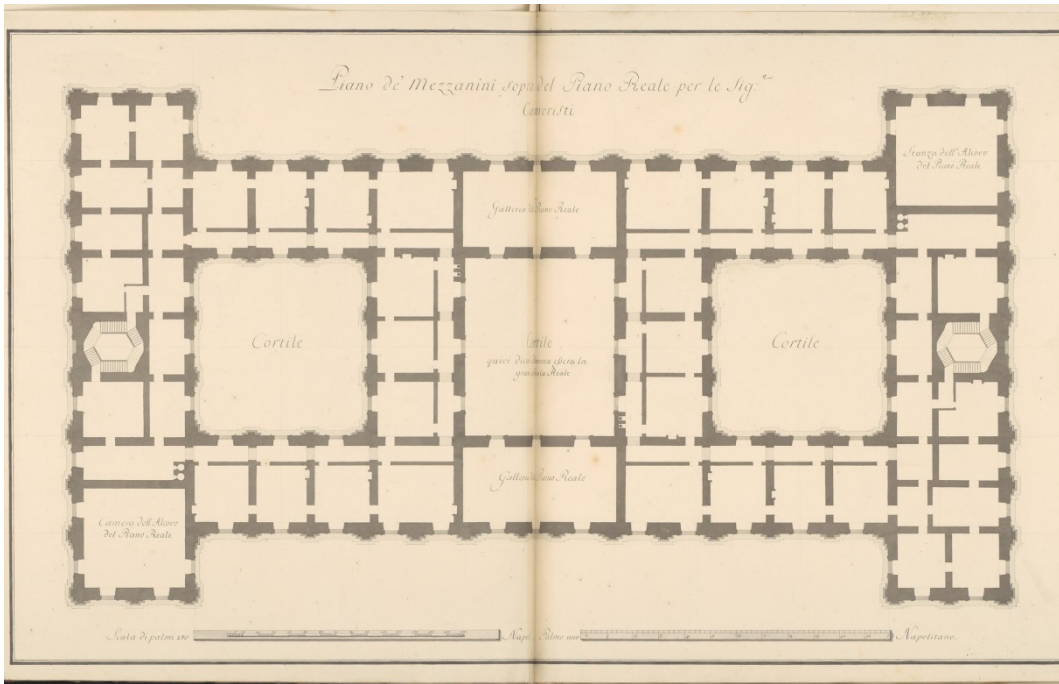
Piano de' Mezzanini sopra del Piano Reale per le Sig:e Cameristi, dopo il 1769, VAM, Prints, Drawings & Paintings Collection (Museum number: E.22:21-2001; Gallery location: Prints & Drawings Study Room, level D, case ABOVE115LL, shelf LL44)
